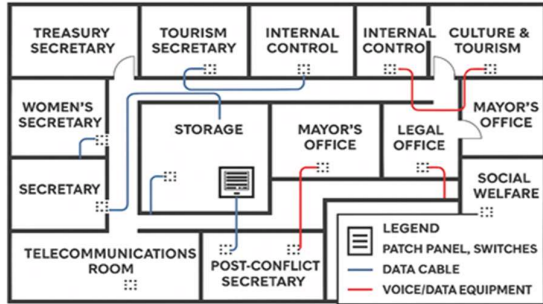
Distribución del proyecto. Layout Piso Tres. (Fuente: elaboración propia, 2025).
